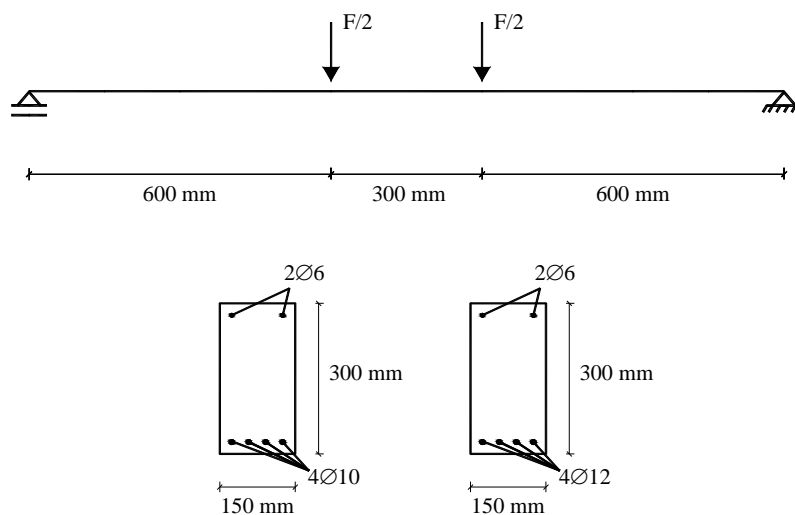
Modelo estrutural e as secções transversais das vigas da série A.
